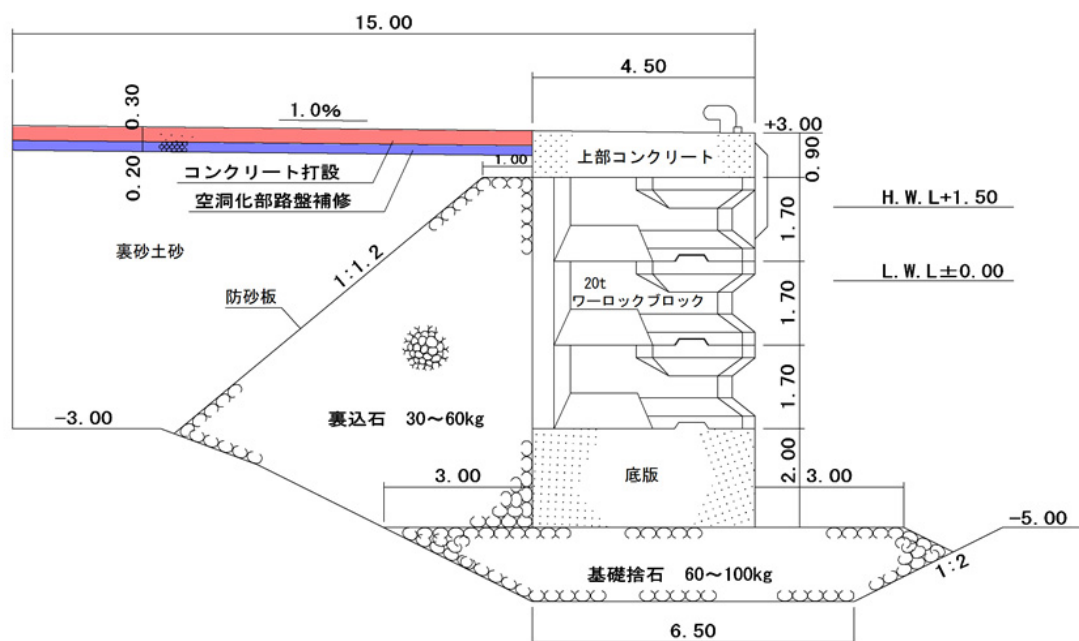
No.29 大洗港区\_第1埠頭C物揚場(-2.0m) (水産ふ頭地区)の断面図(復旧後)
